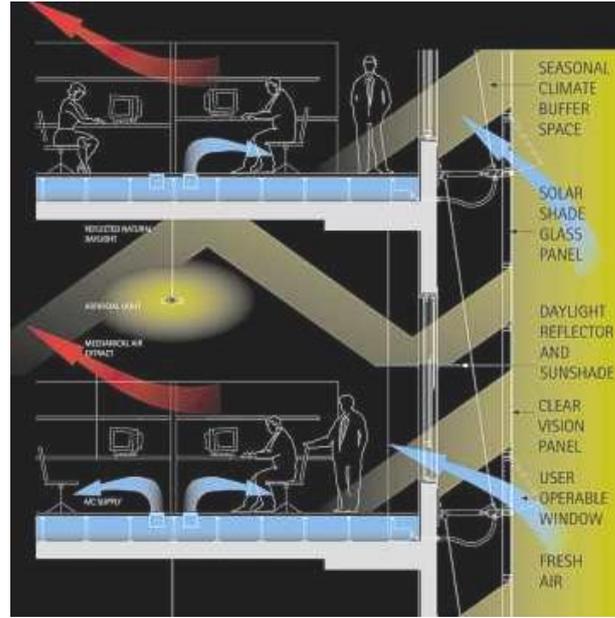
مكونات ال-Double Layered Façade - قطاع رأسى
